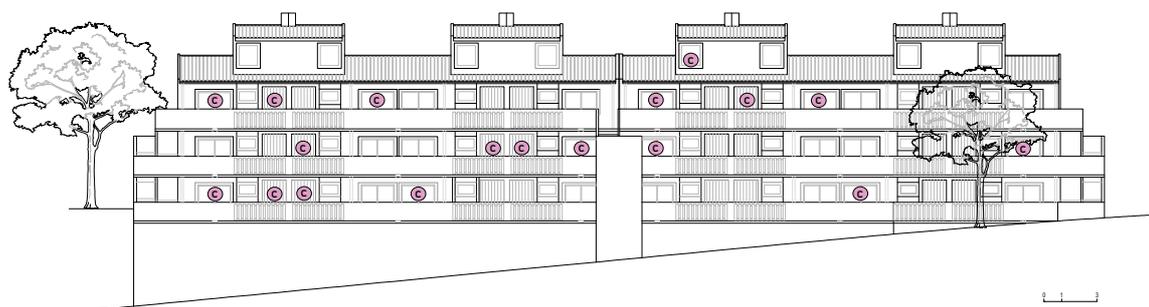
Alçado com as alterações dos vãos das janelas no lote 1
